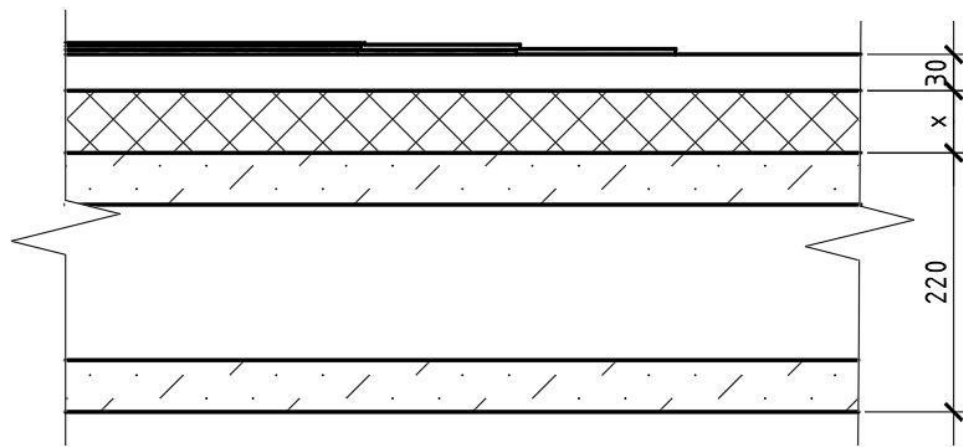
Ескіз перерізу перекриття для розрахунку
